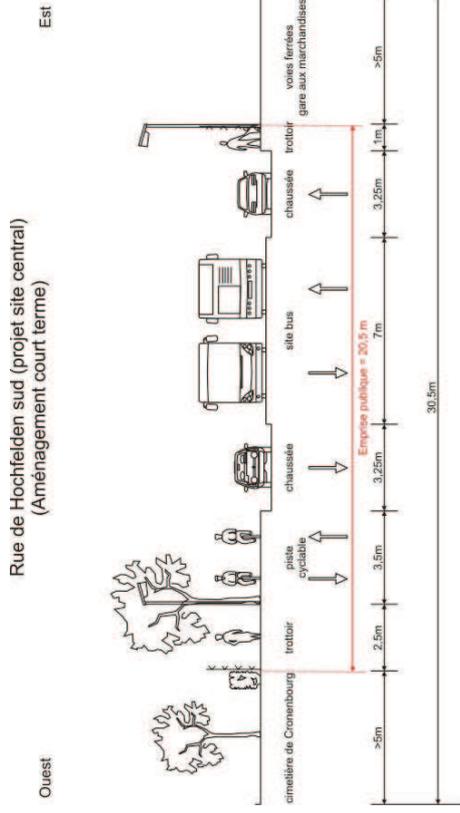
Situation projetée (coupe 20) route de Hochfelden (aménagement à court terme)
